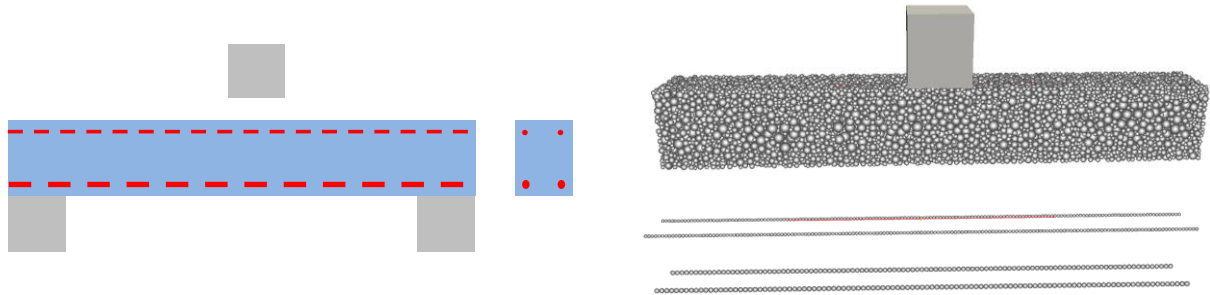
Schéma du problème et maillage éléments discrets de la poutre et des armatures.
